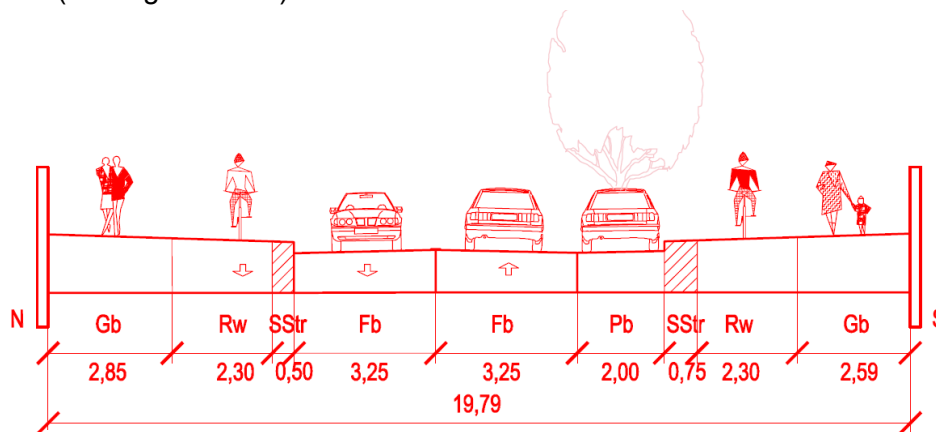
Schematische Darstellung Querschnitt Rheinstraße - Planung Variante 2
